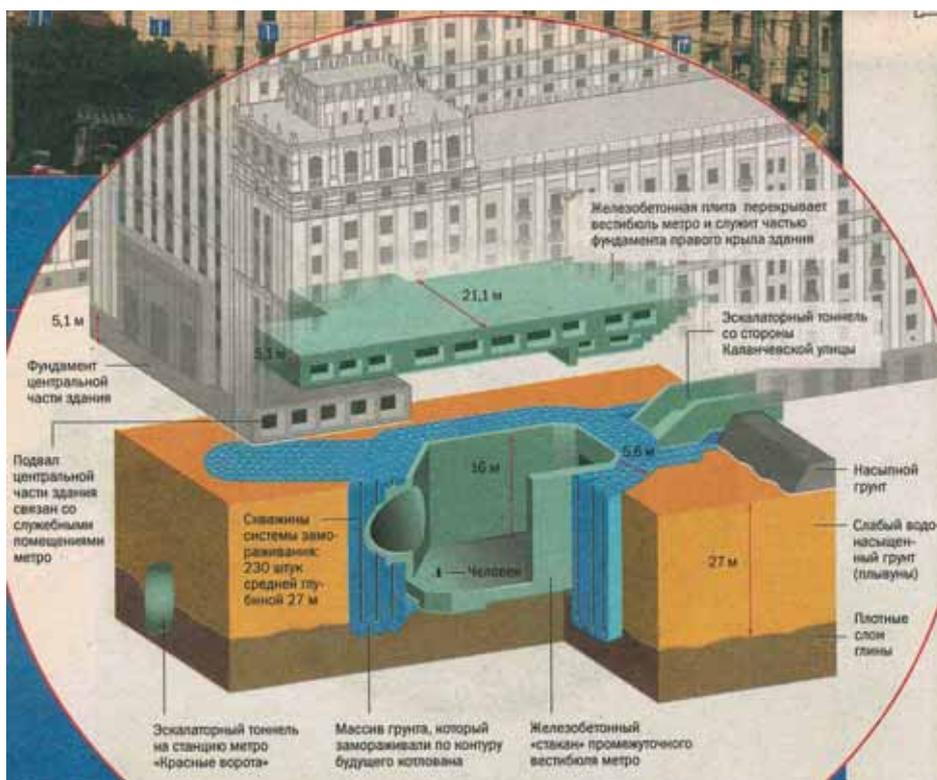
Вид на правое крыло высотного здания на Красных Воротах с выходом из метро
